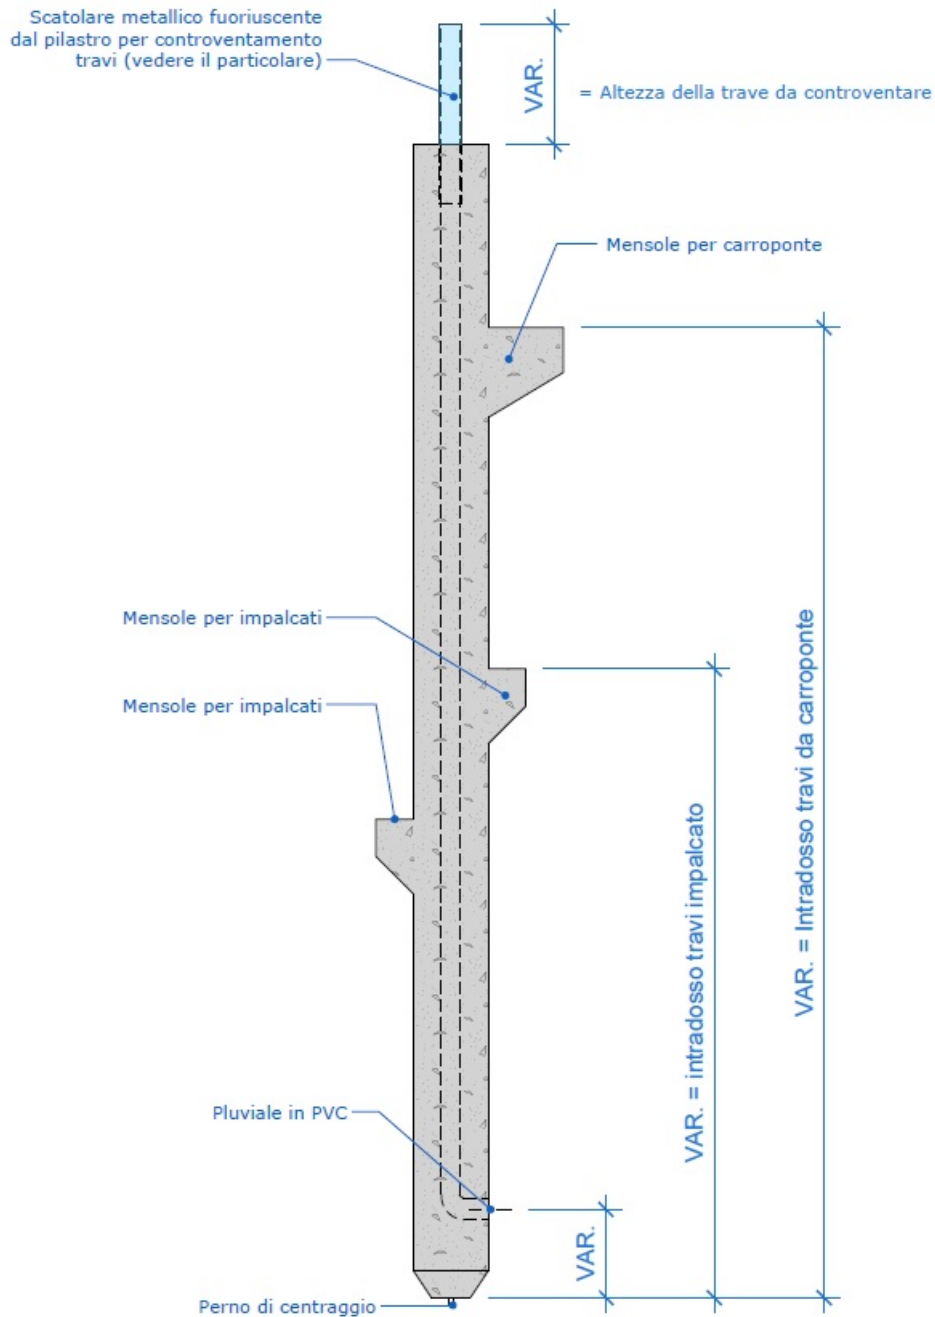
Pilastro prefabbricato in calcestruzzo armato. Fonte impresa "Tre Colli".
